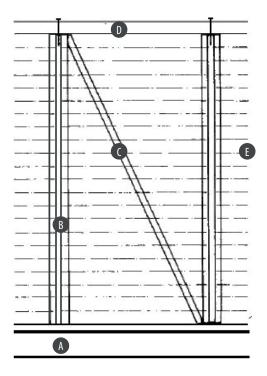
Sistema constructivo bahareque. Fuente: Rivera (2021)- Adaptado por el Autor (2024)
